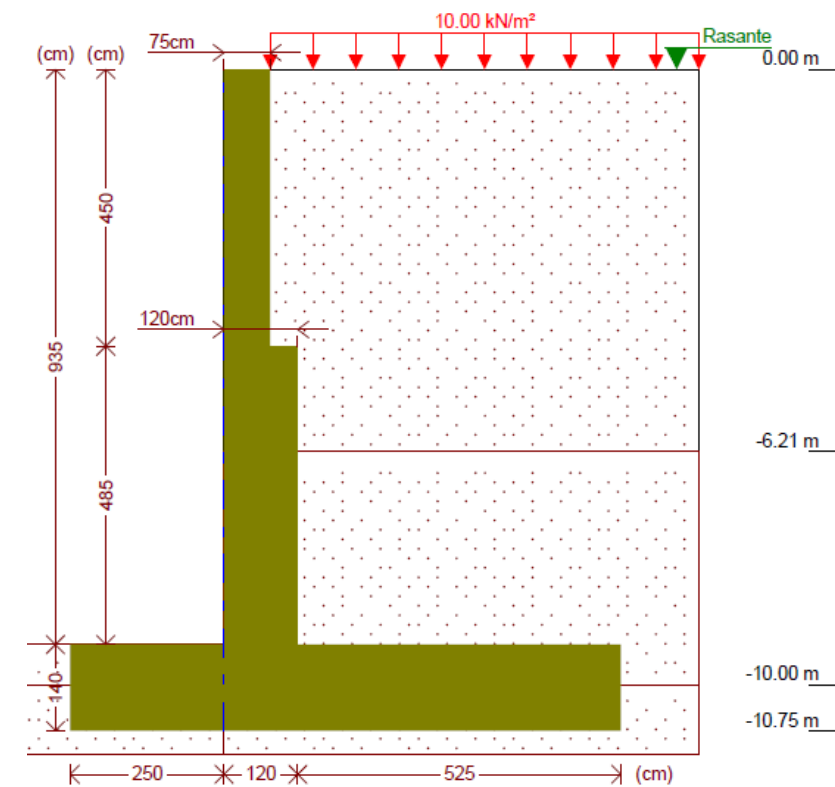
Alzado del muro de vuelta en el estribo 1
